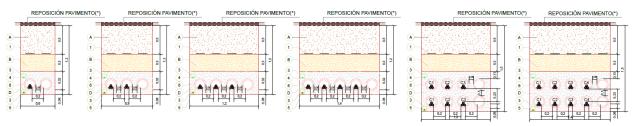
zanjas tipo conductor entubado bajo viales/caminos o drenajes.
